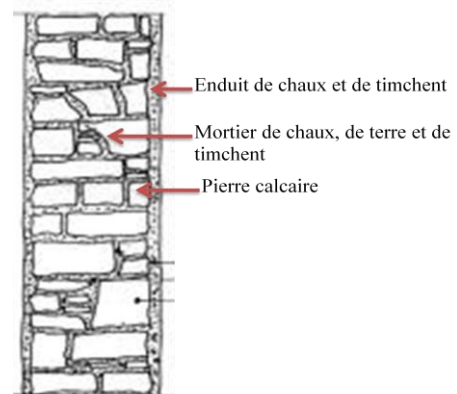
Principe constructif d'un mur en pierre brute hourdée.
